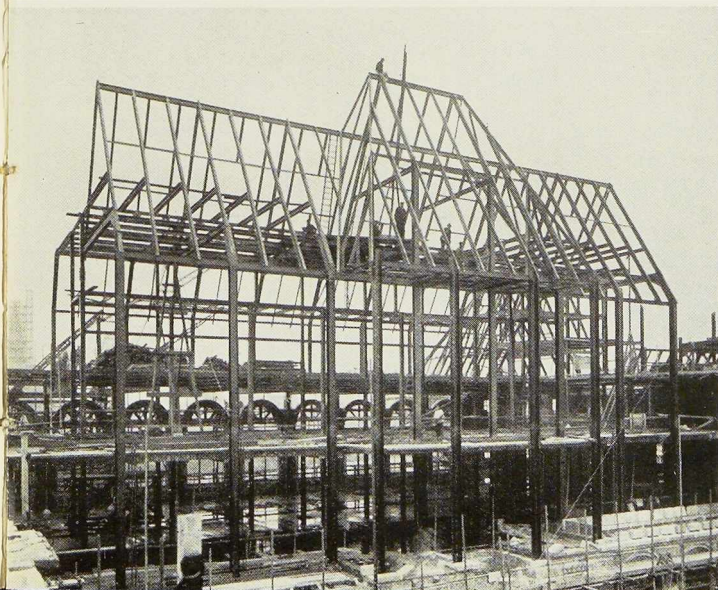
Vue de l'ossature de l'aile Est en construction. On voit notamment la poutre en treillis du balcon du théâtre.
